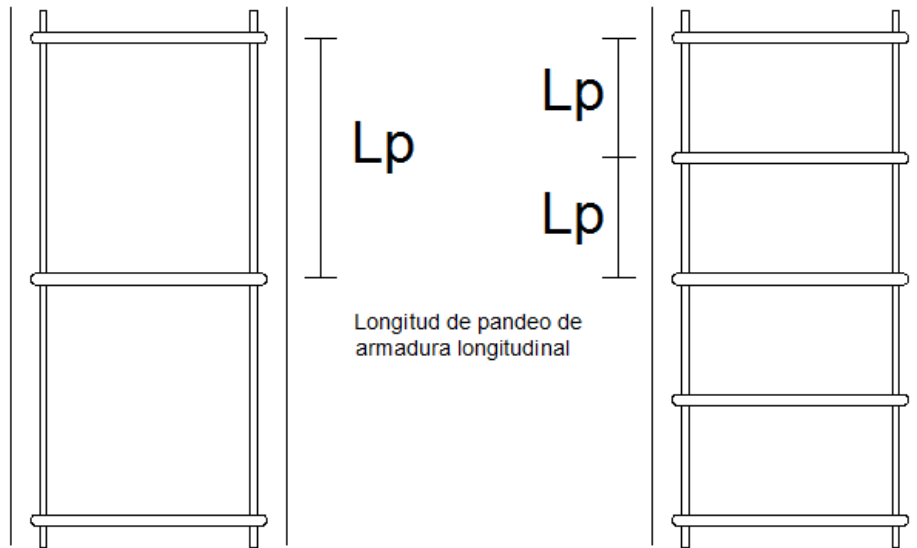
Longitud de pandeo de las barras longitudinales.
